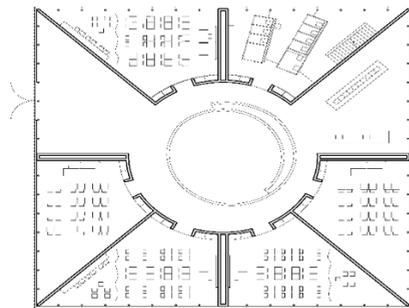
Schulhaus Gelb. Grundriss.
